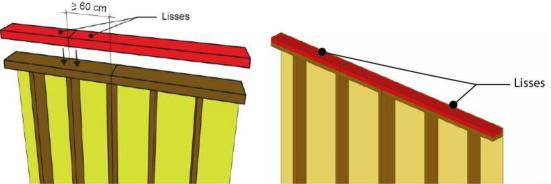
Exemple de mise en œuvre de la lisse haute sur des parois dans le même plan
